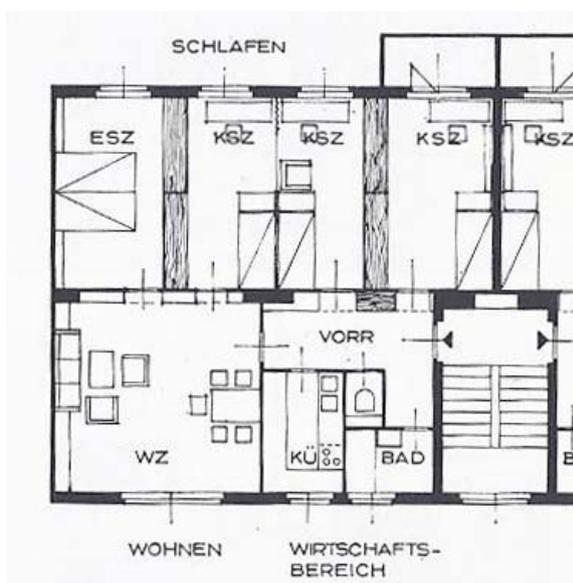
Wohnhausanlage Mauerbachstraße, Saalwohnung, Variante 1
